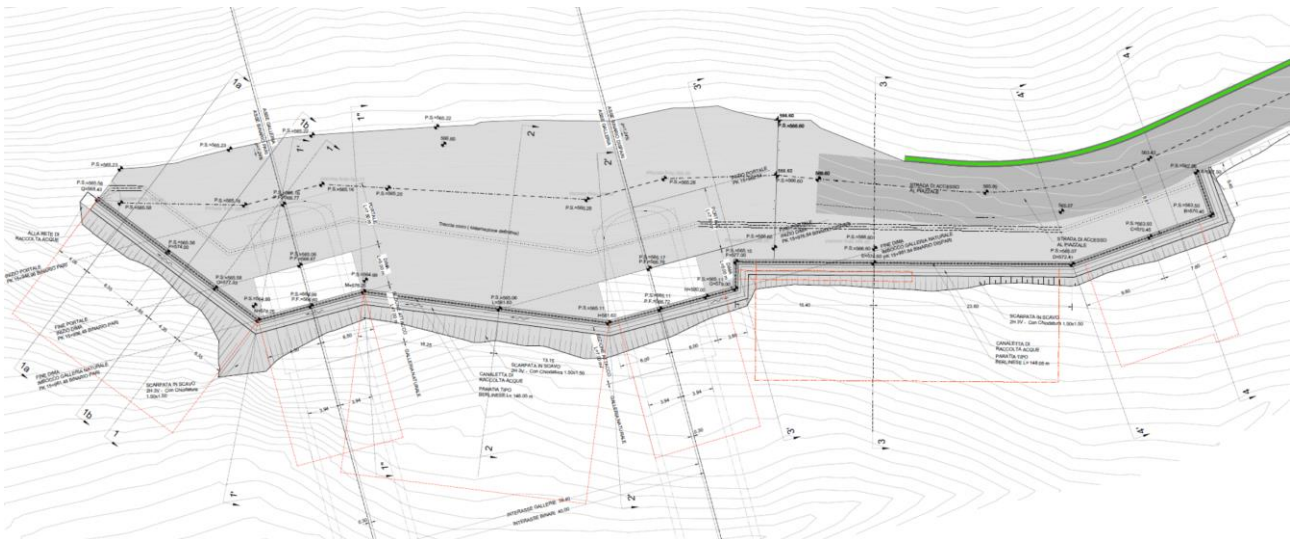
Galleria Gardena – Imbocco Nord – Planimetria delle opere in fase provvisoria
